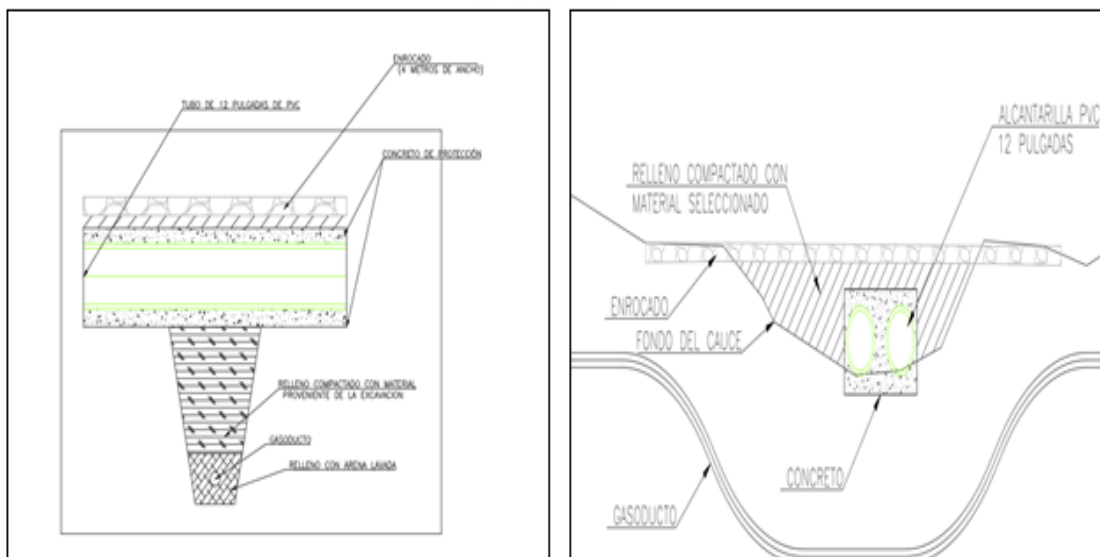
Esquema de cruce con enrocado y alcantarilla.
